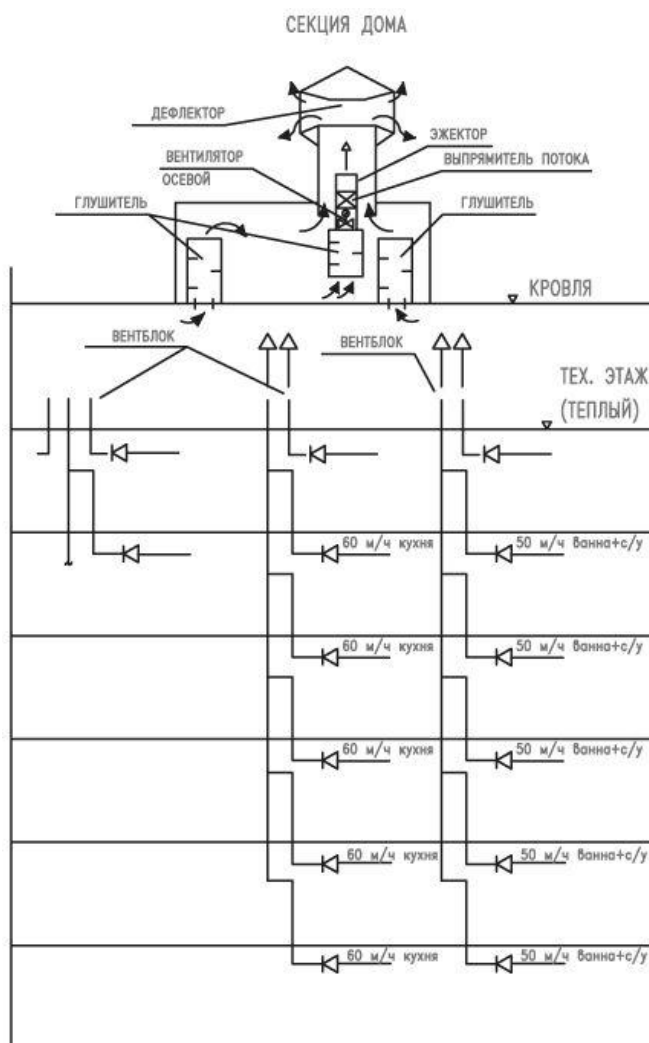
Принципиальная схема вентиляции квартир жилого дома (вентиляционная камера с одним дефлектором)
